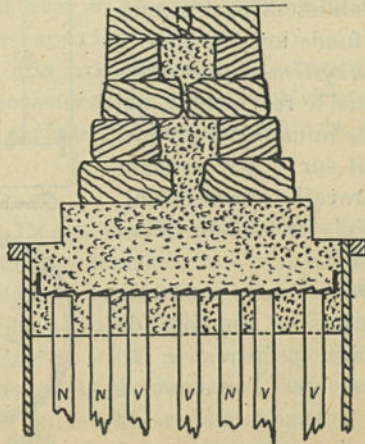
Fondation des piles du Penrose Ferry Bridge à Philadelphie.
